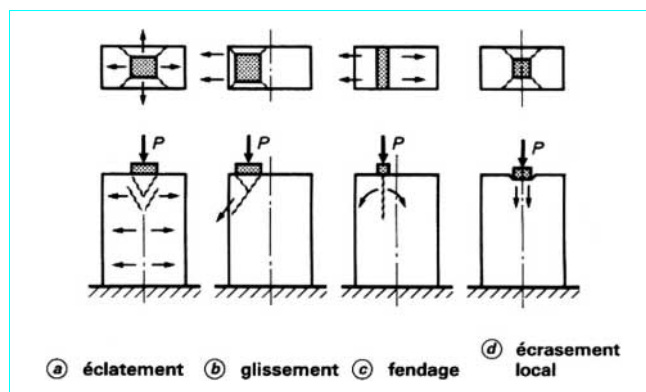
Modes de rupture d'un prisme de béton soumis à des pressions localisées
